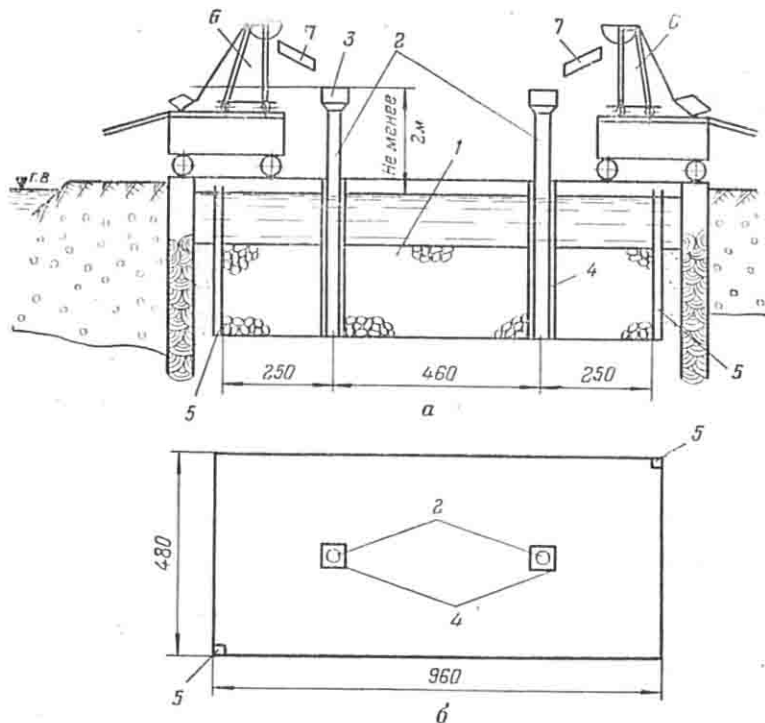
Производство бутовой кладки фундамента методом нисходящего раствора:
